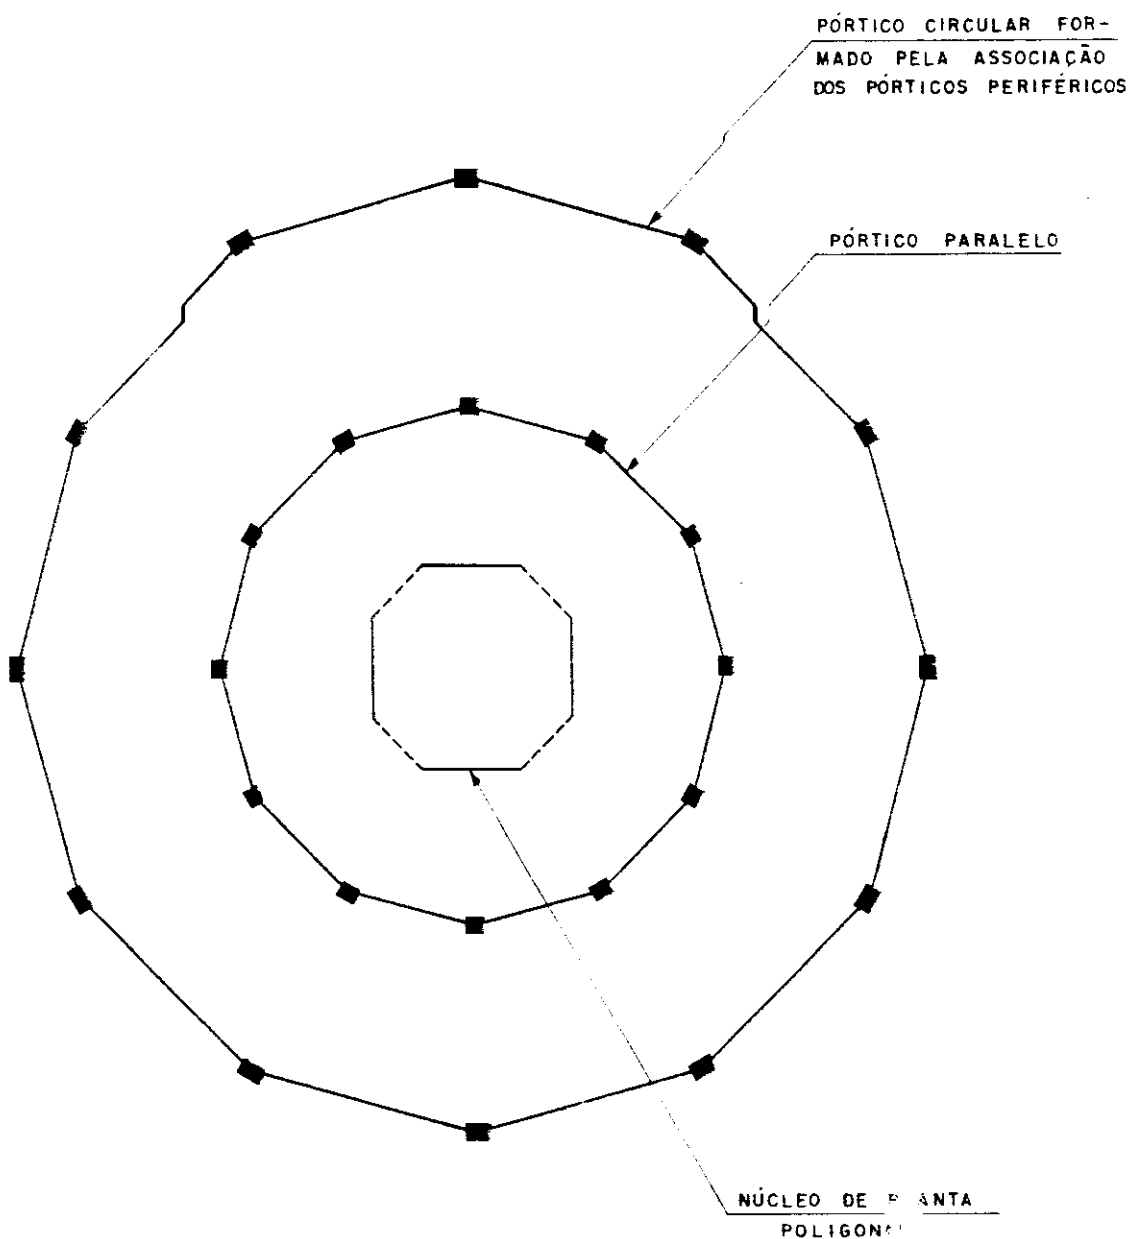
Planta do tipo de edifício mais geral deste trabalho.
